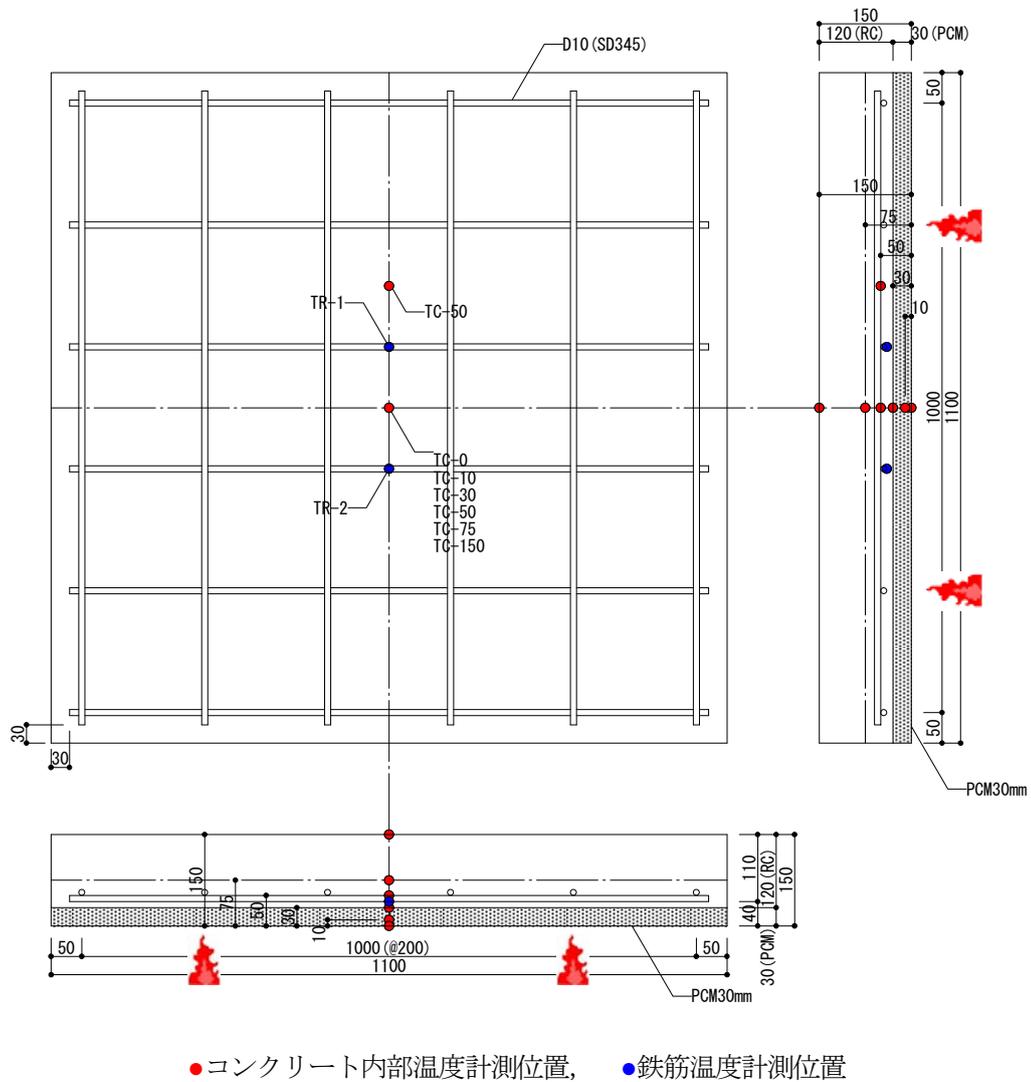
試験体の形状, 配筋, および部材内部の温度計測位置
